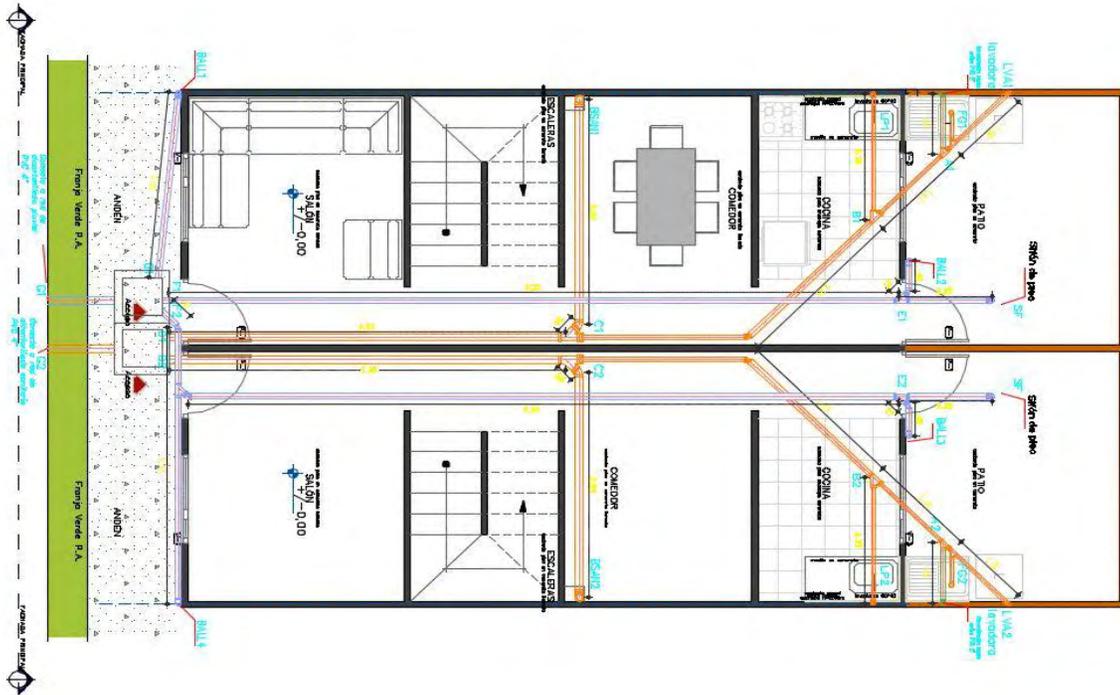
Trazado en planta red sanitaria y de aguas lluvias vivienda tipo – Piso 2
